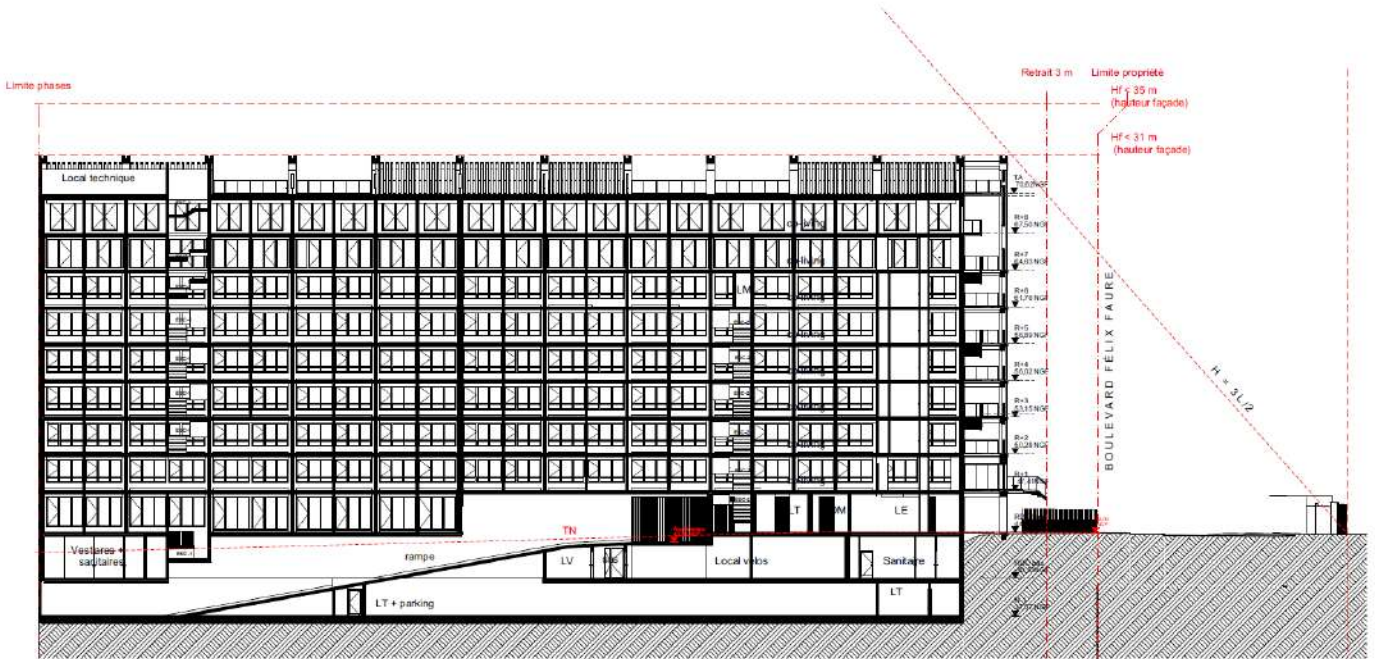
Coupe longitudinale du projet (janvier 2024)
